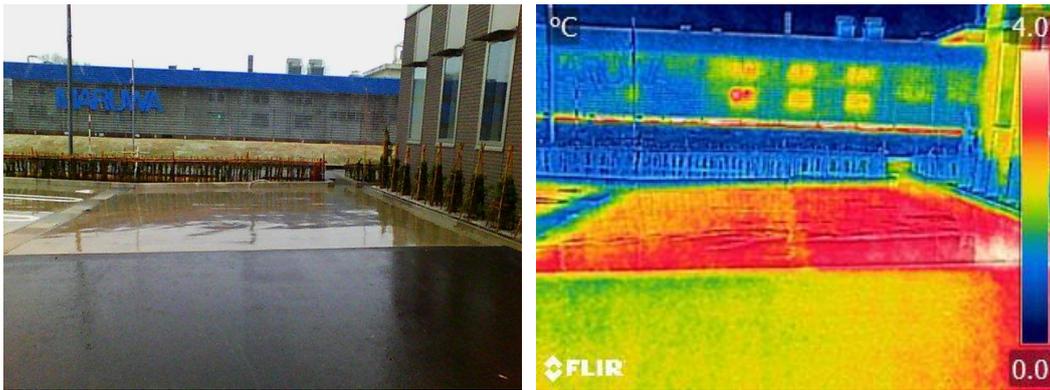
東面融雪状況①（敷設ピッチ 300 mm 融雪パターン②）
